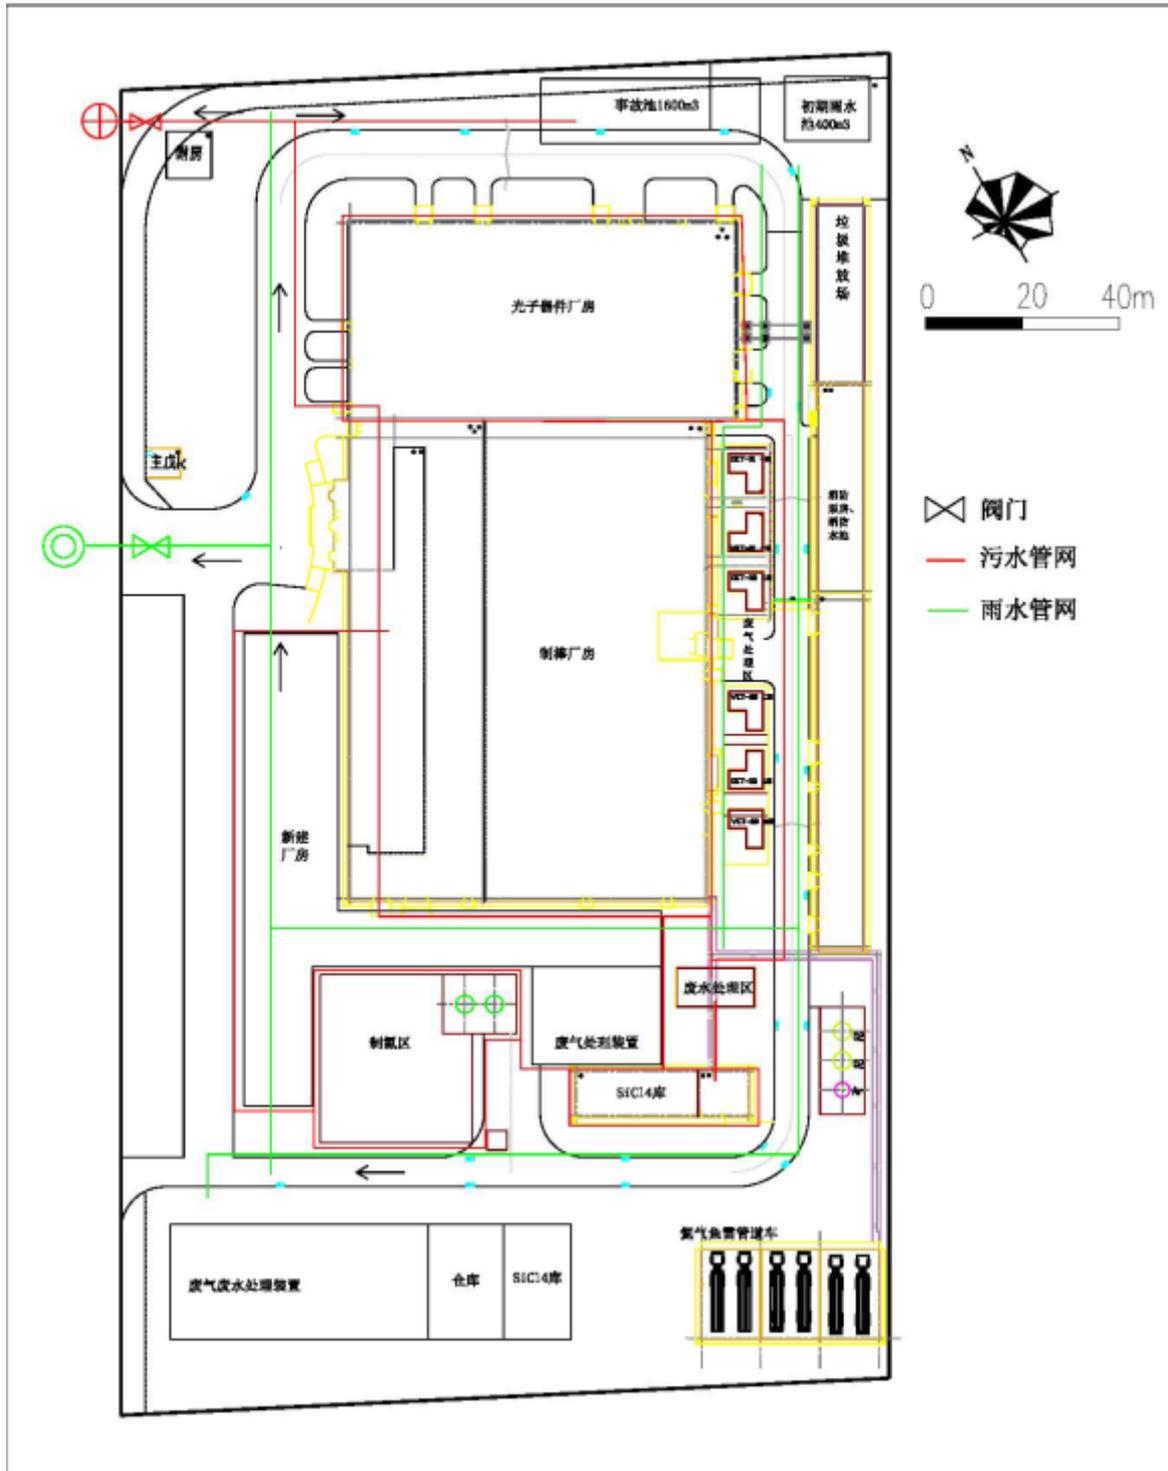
中天科技精密材料有限公司平面布置图及雨污水管网图
